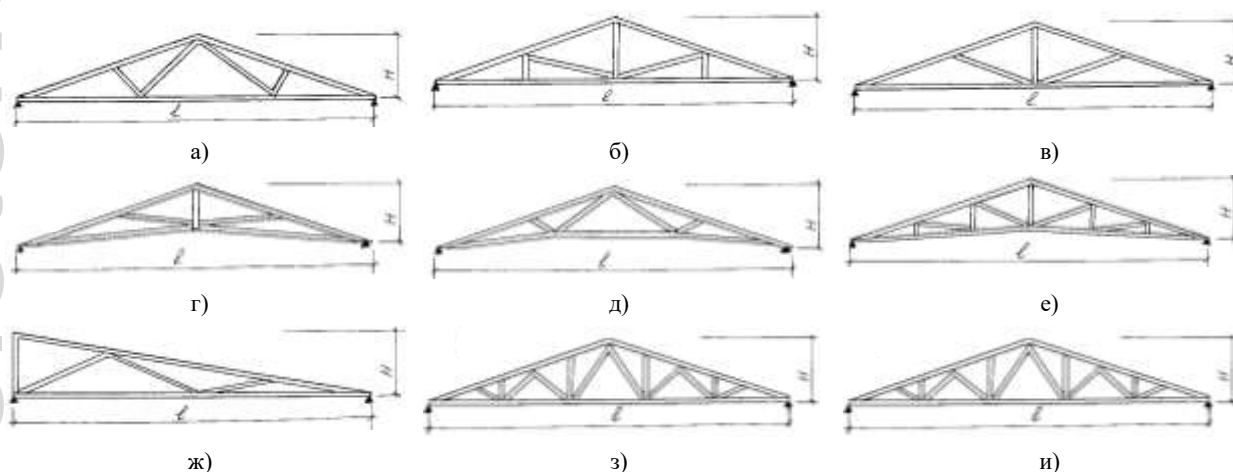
Основные типы деревянных ферм на металлических зубчатых пластинах:
